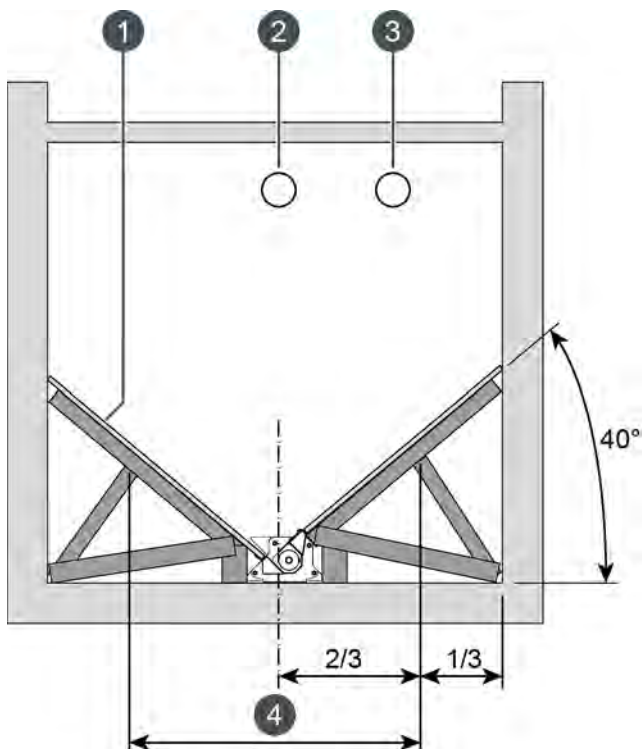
Construction du plancher incliné pour la vis d'alimentation
